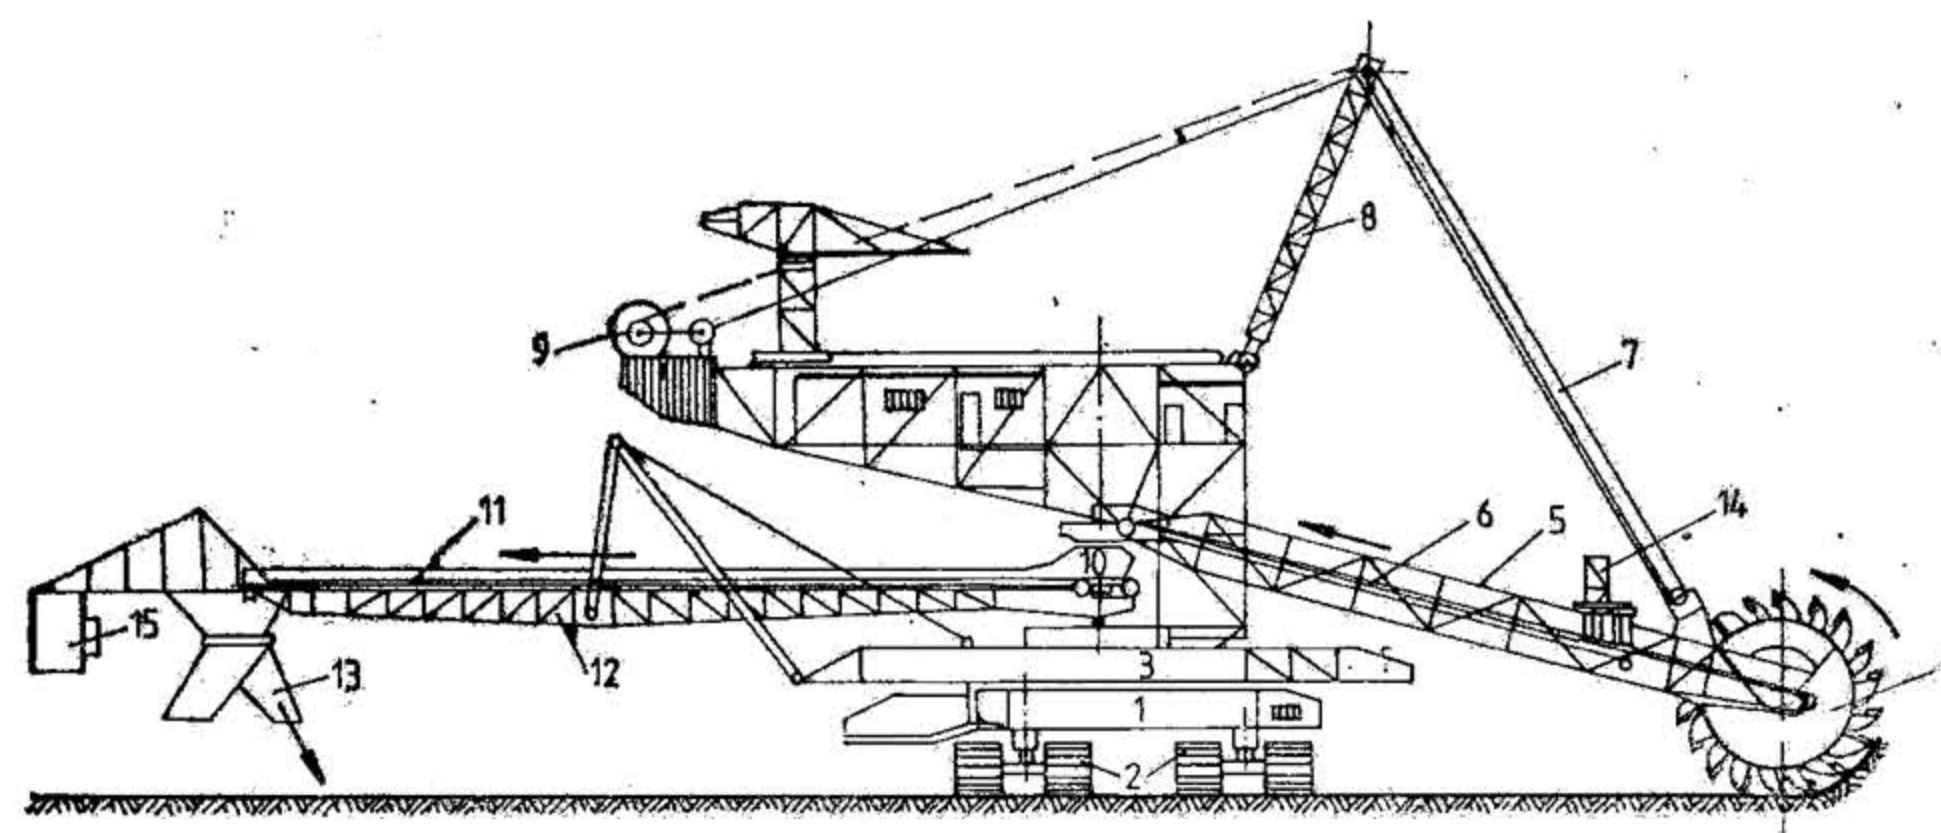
Schema constructivă a excavatorului cu rotor și cupe tăietoare cu braț de depunere nerezemat:
